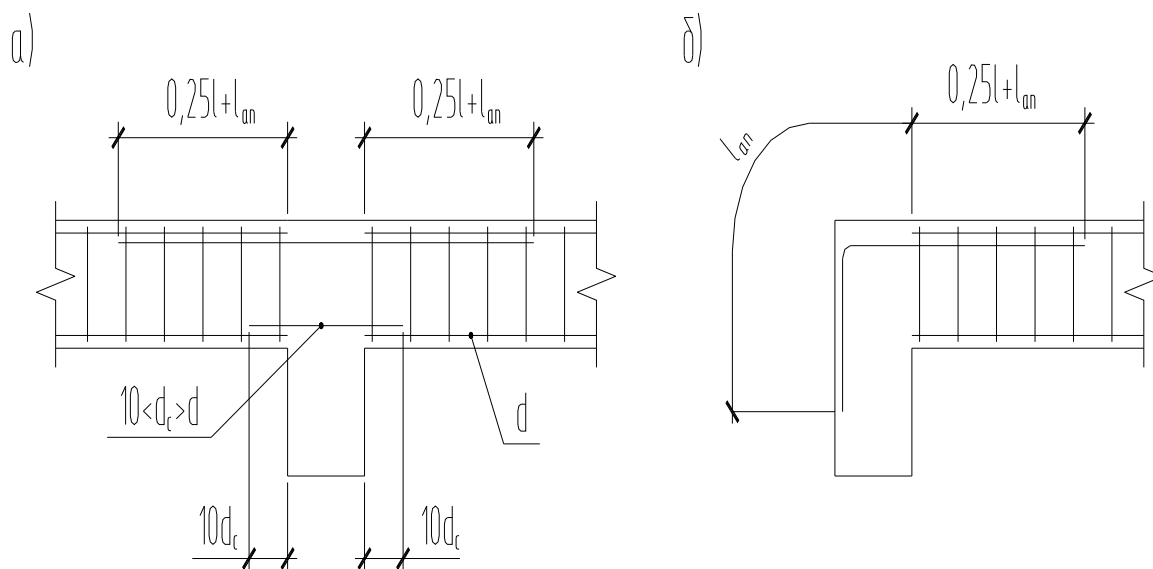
Арматування опорних вузлів другорядних балок:
